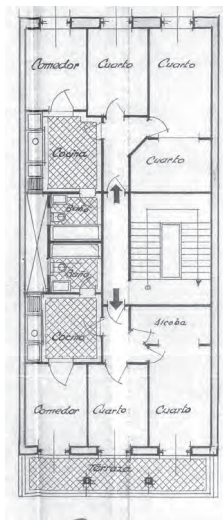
15. PRIMERA Y SEGUNDA PLANTA
